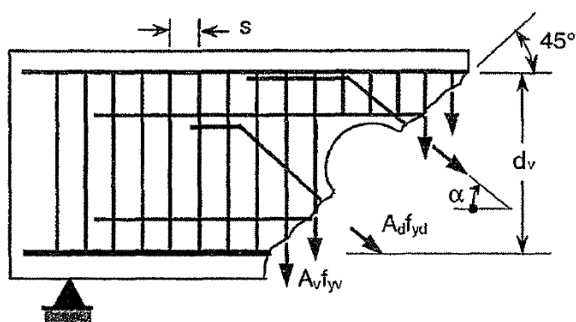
Darstellung des Kräfteverlaufs in der Bewehrung bei einer Öffnung aus [4]
